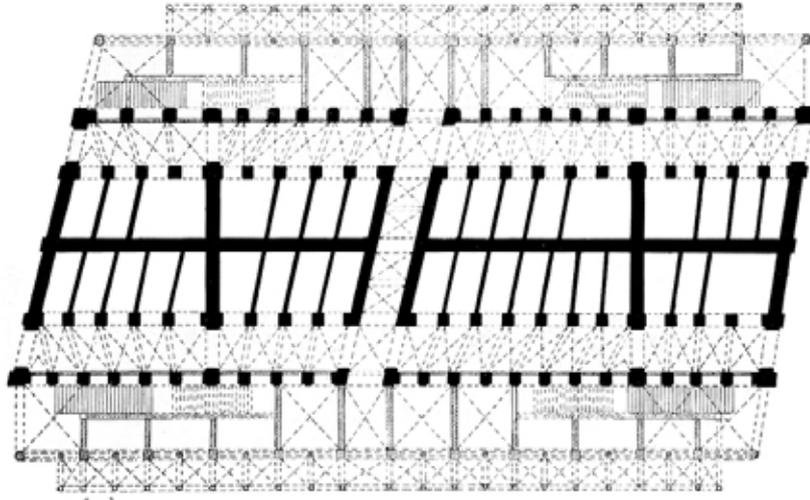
Palazzo della Ragione, Grundriss Erdgeschoss
